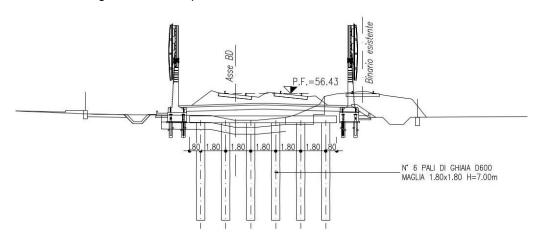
Sezione tipo in rilevato dell'intervento di consolidazione
